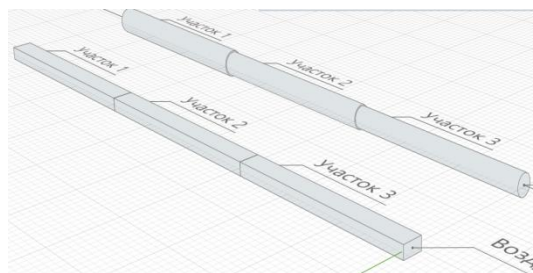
Воздуховоды круглого и прямоугольного сечений
